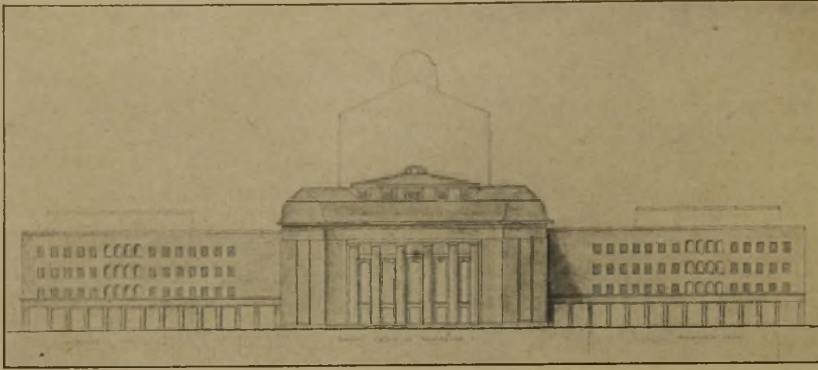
Theater mit der nach der Hankestraße hin anschließenden Bebauung.
